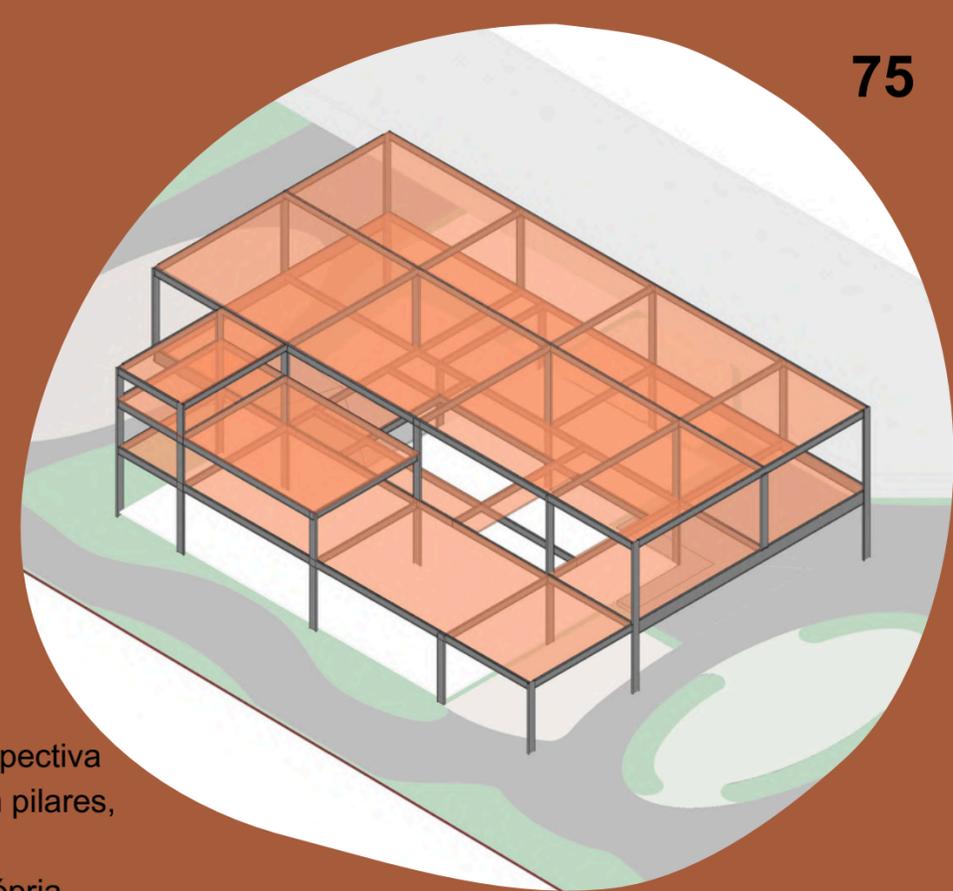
Perspectiva esquemática com pilares, vigas e lajes
